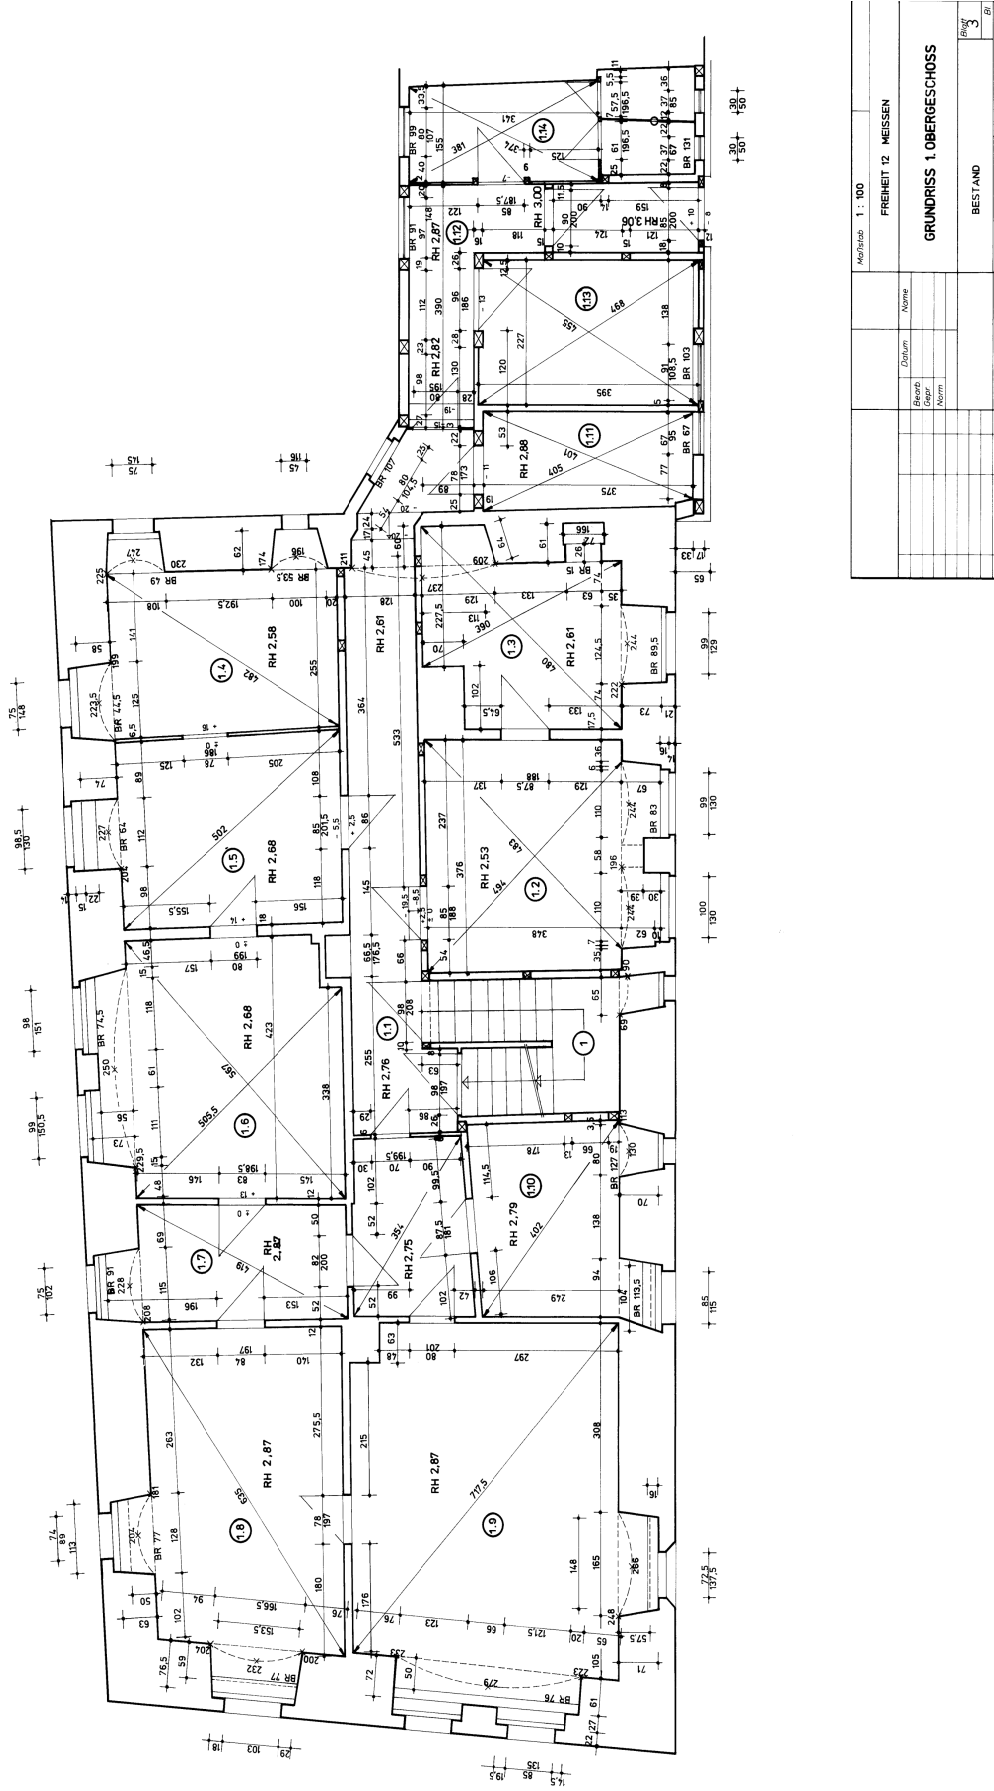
Freiheit 12, Grundriss Obergeschoss Bestand
